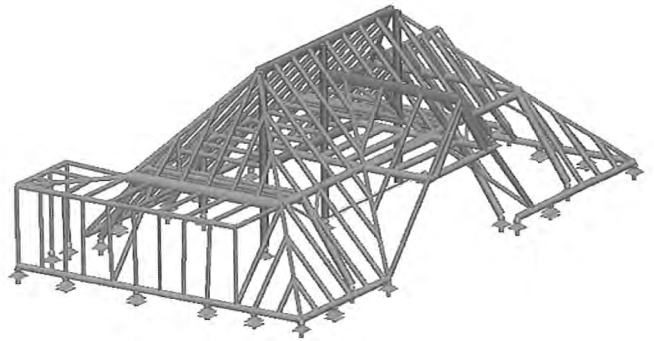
Bestehendes Dachtragwerk als dreidimensionales Stabwerksmodell
